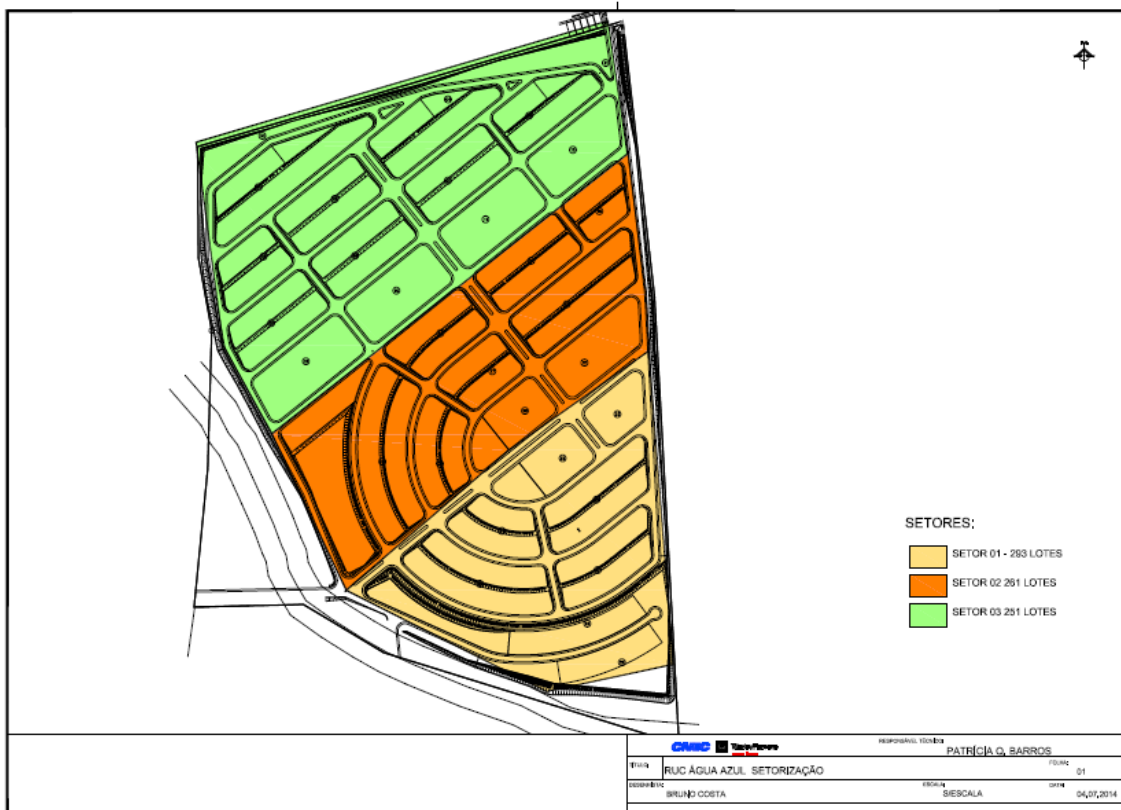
4 - Setorização do bairro Água Azul.
